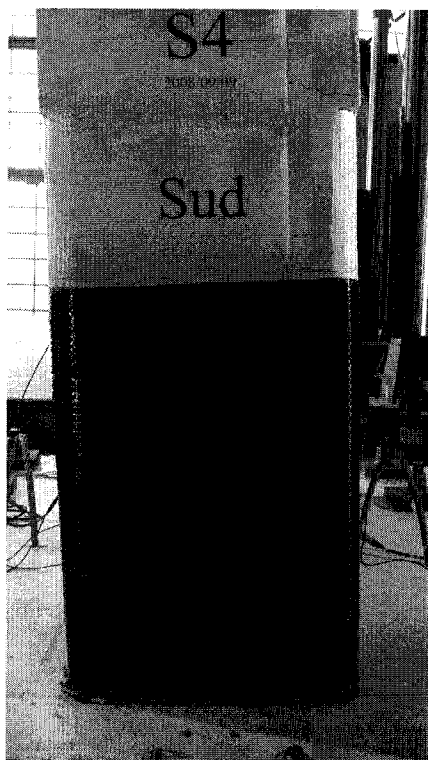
Photo de la face sud de S4 à la fin de l'essai
